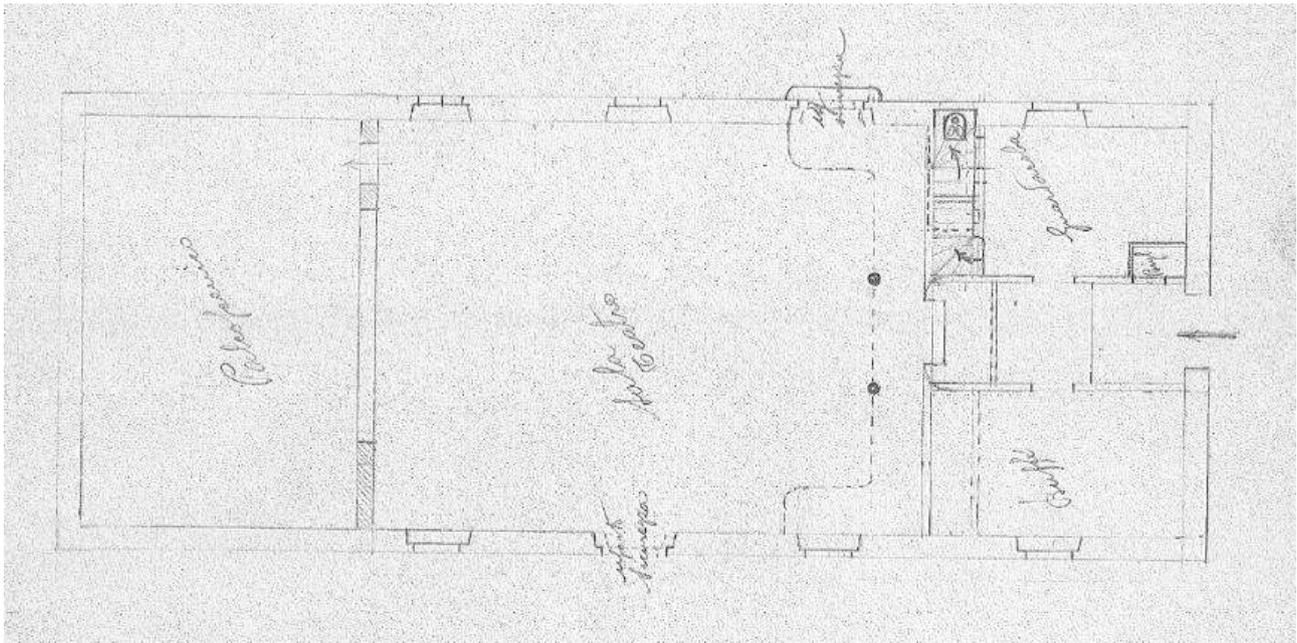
Planimetria edificio, 1924. FONTE: Archivio Privato
